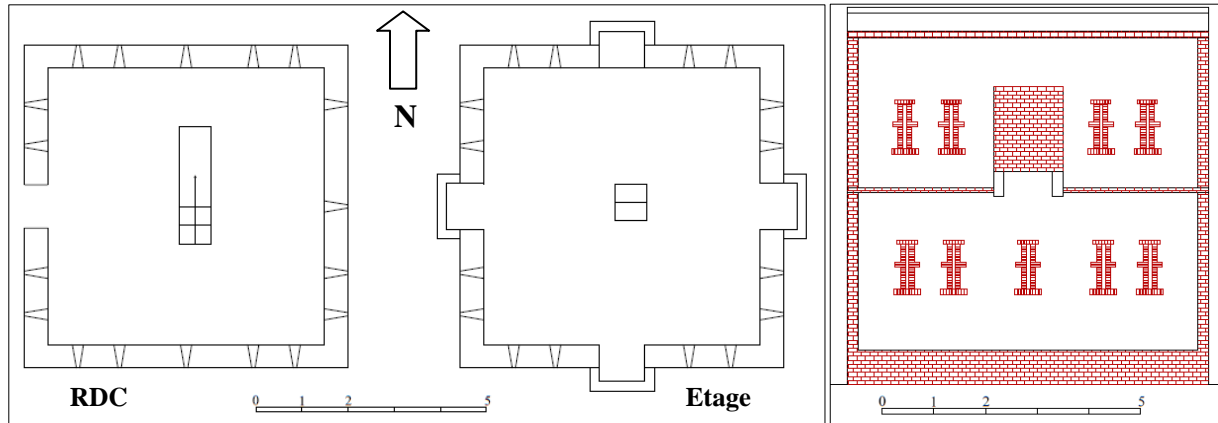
plans et façade sud du blockhaus N° 9.
